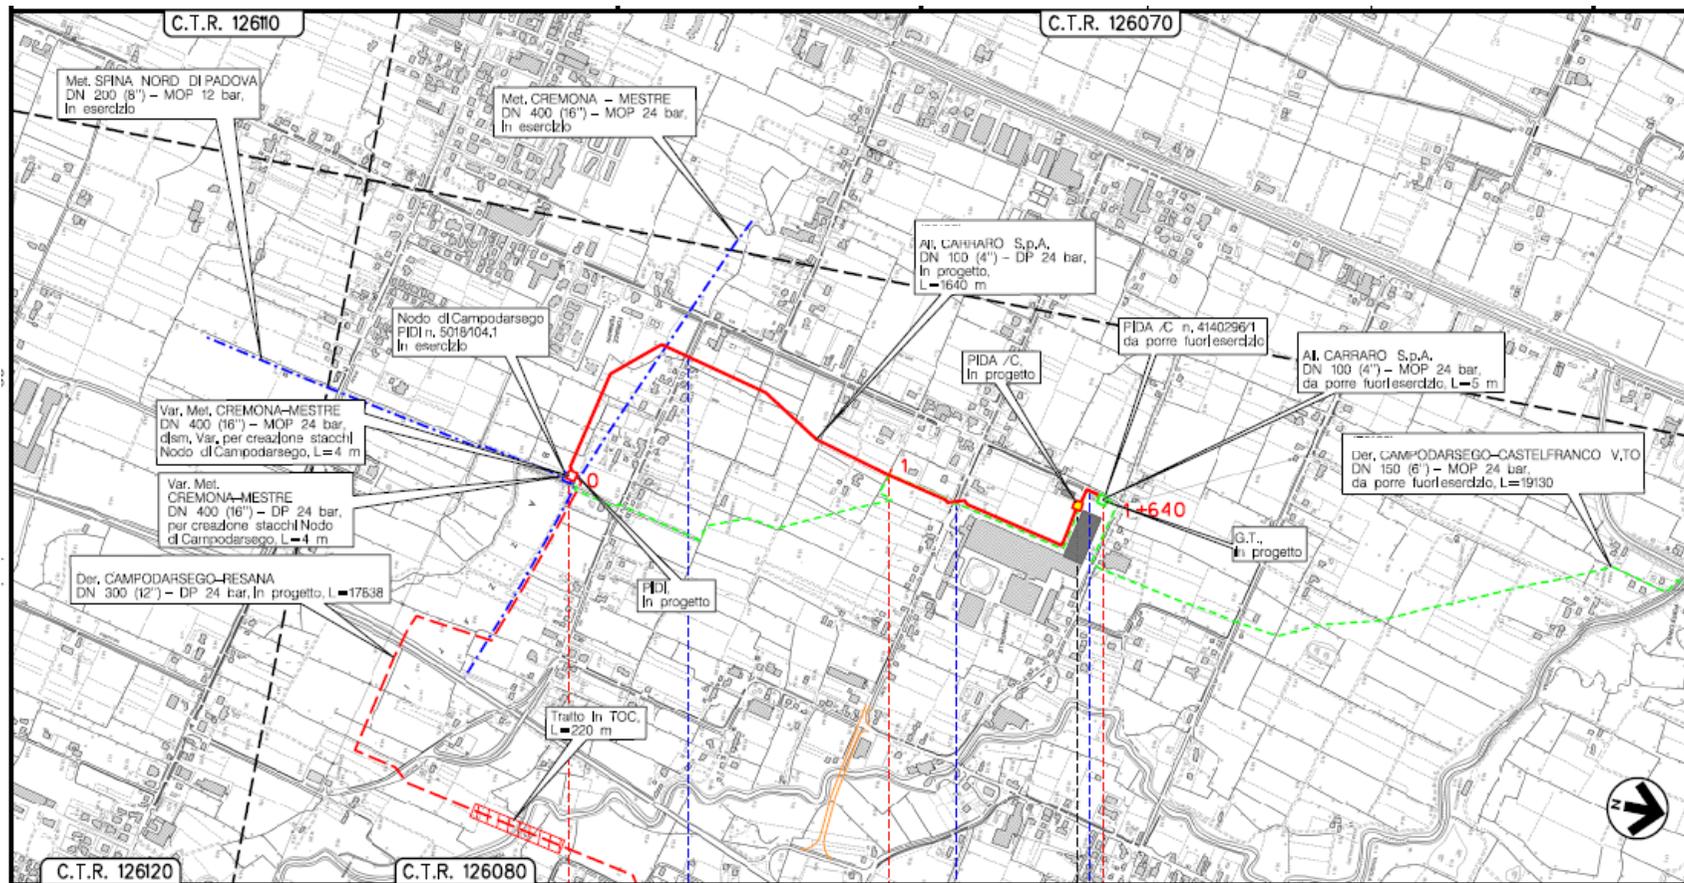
RIF. ALL. CARRARO SPA - Stralcio planimetria CTR con localizzazione dell'area di intervento
